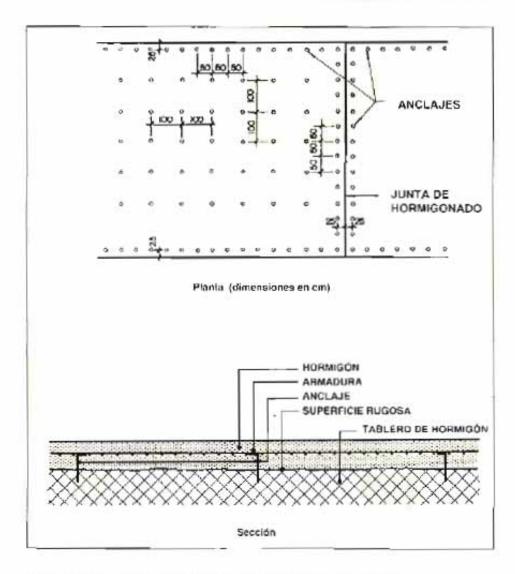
Pavimento adherido según la norma suiza SN-640461 a.
